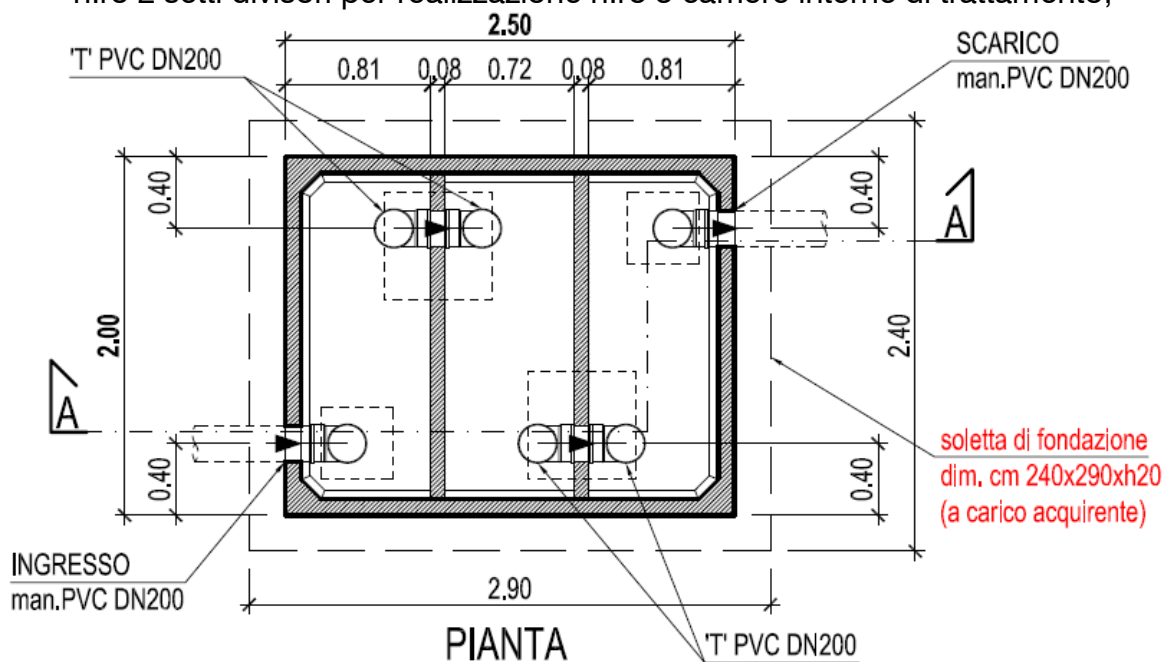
Vasca di decantazione prefabbricata – Tipologico
